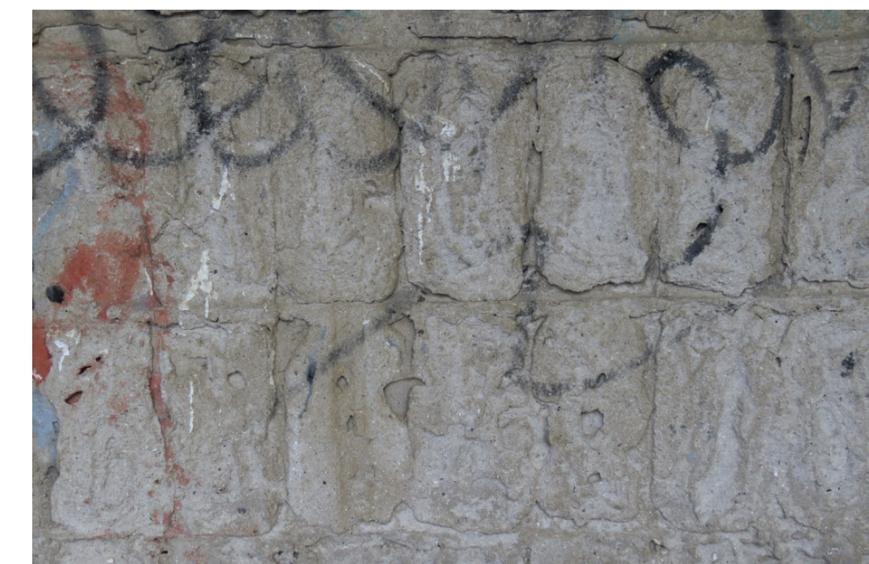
(abajo). Desprendimiento de los elementos decorativos del muro debido a tensiones y falta de adhesión (acantilado visible).
